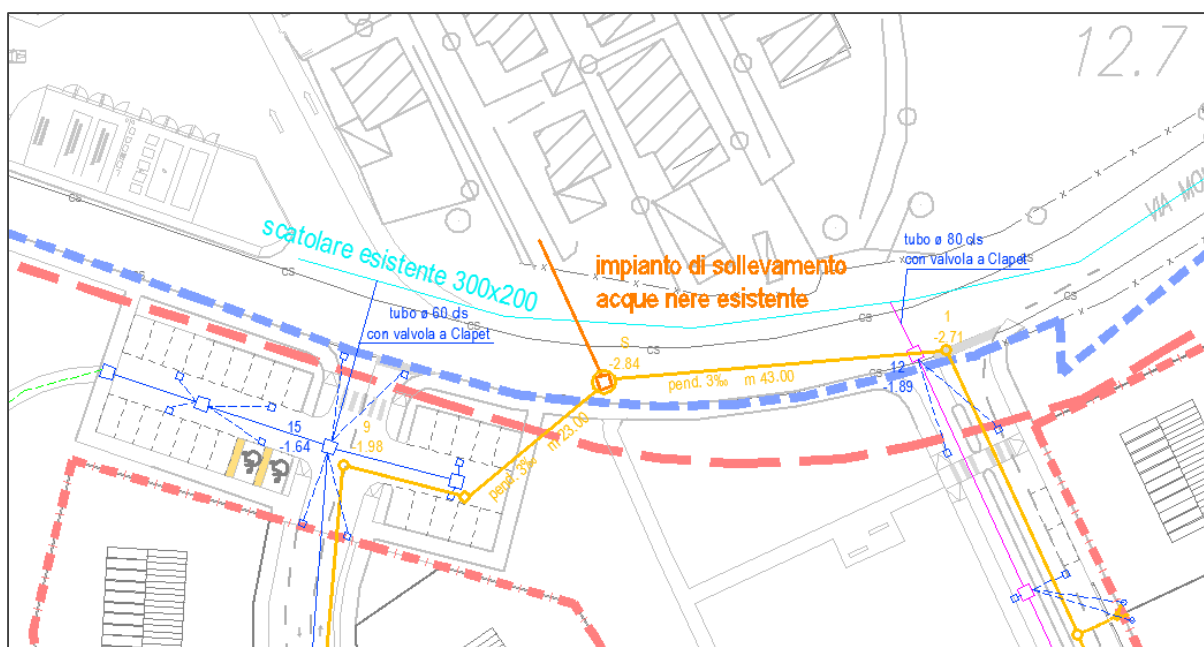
Estratto dalla tavola 8 di progetto - Schema reti acque bianche – nere, zona di scarico
